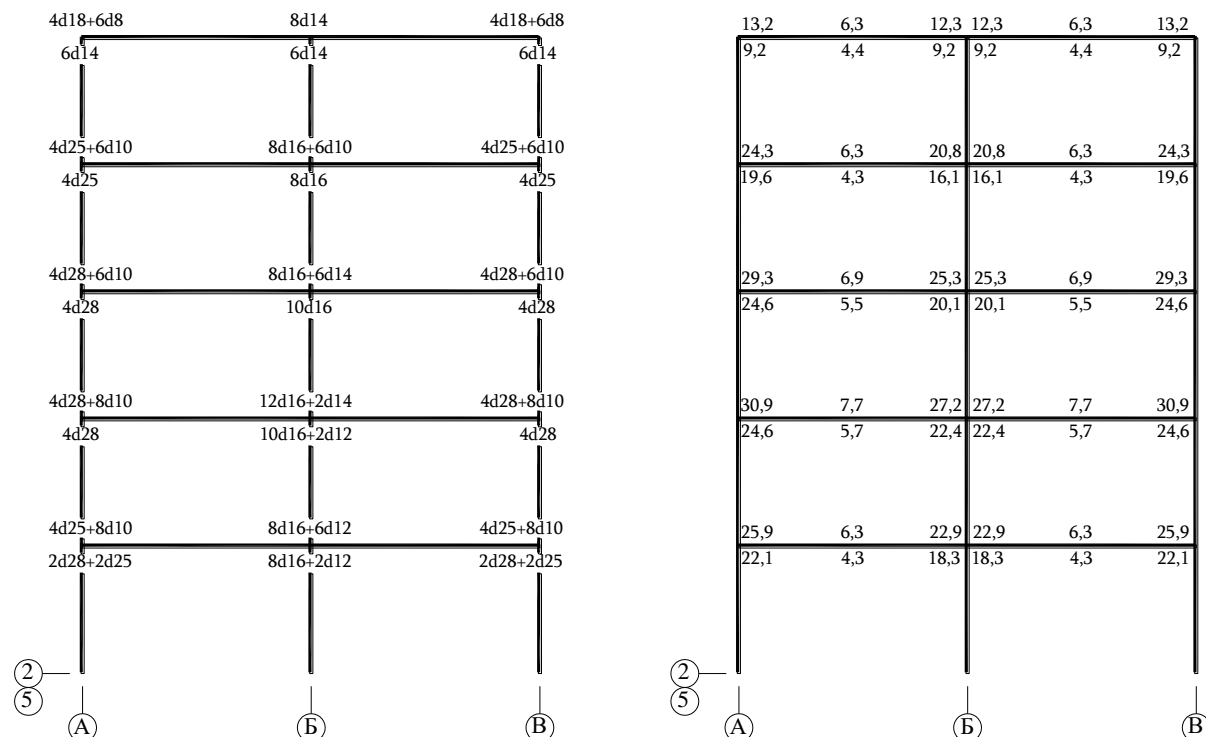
Продольное армирование балок рам, расположенных по осям 2 и 5, в соответствии с результатами конструирования:
